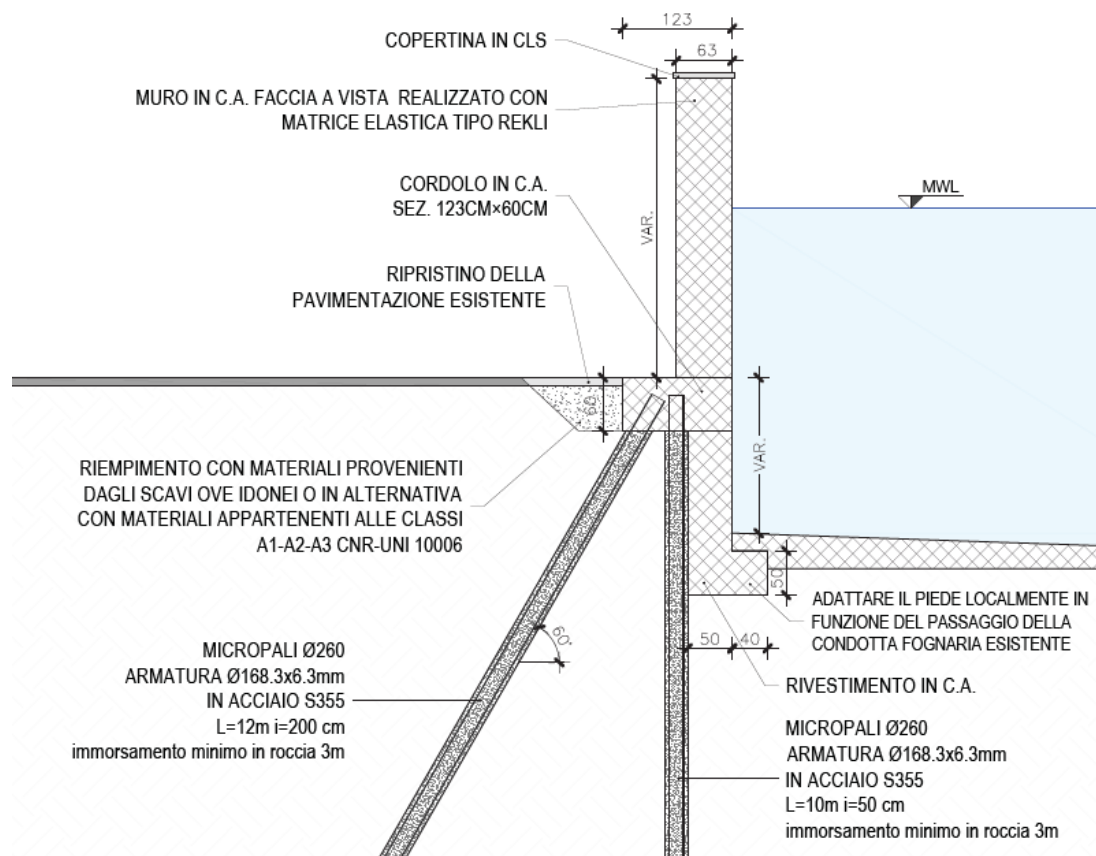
Esempio di sistemazione muro di sponda Villa Pallavicino
